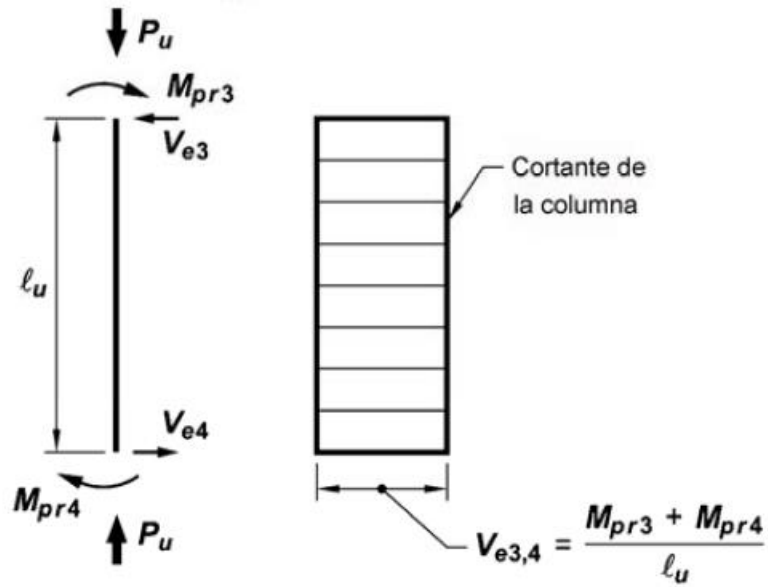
Esfuerzo de corte de las columnas para marcos especiales. Fuente: ACI318 – 08
